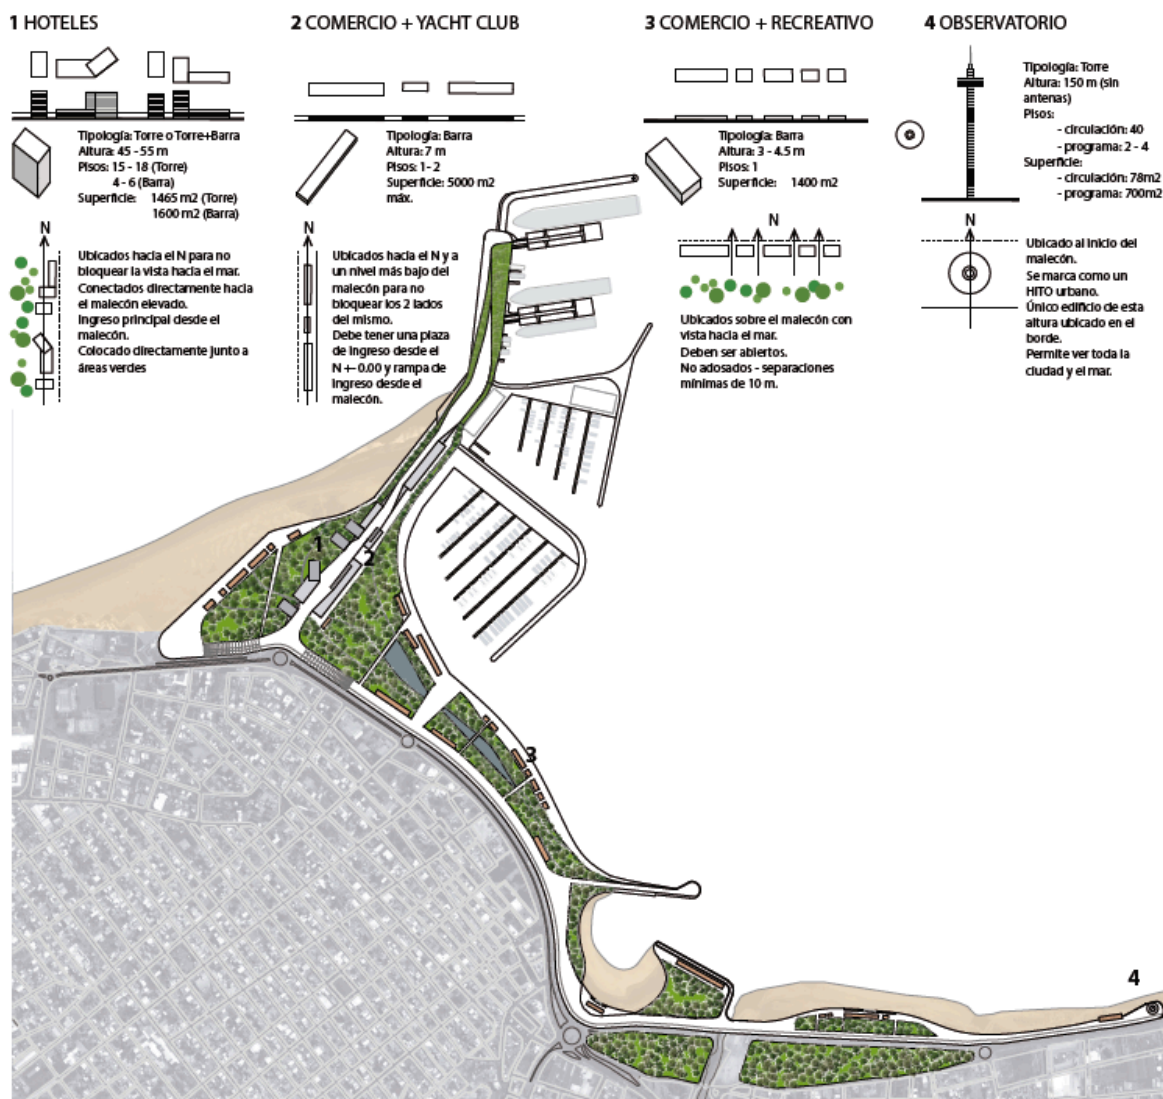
Fase 3 y Desarrollo del Plan Maestro
